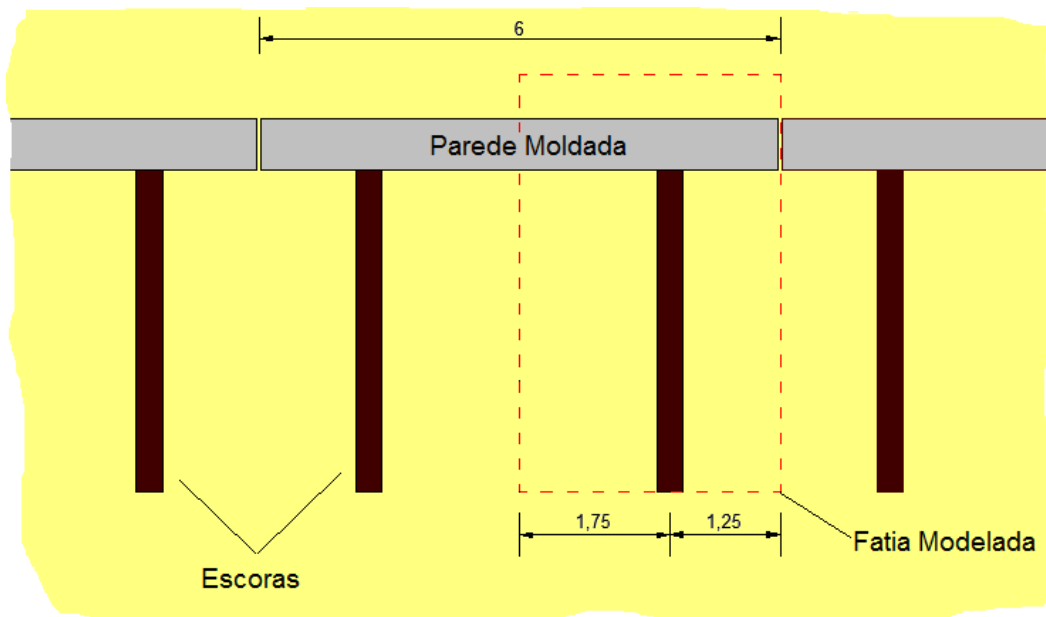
Escavação da estação Terreiro do Paço no plano horizontal e fatia modelada (a tracejado).
